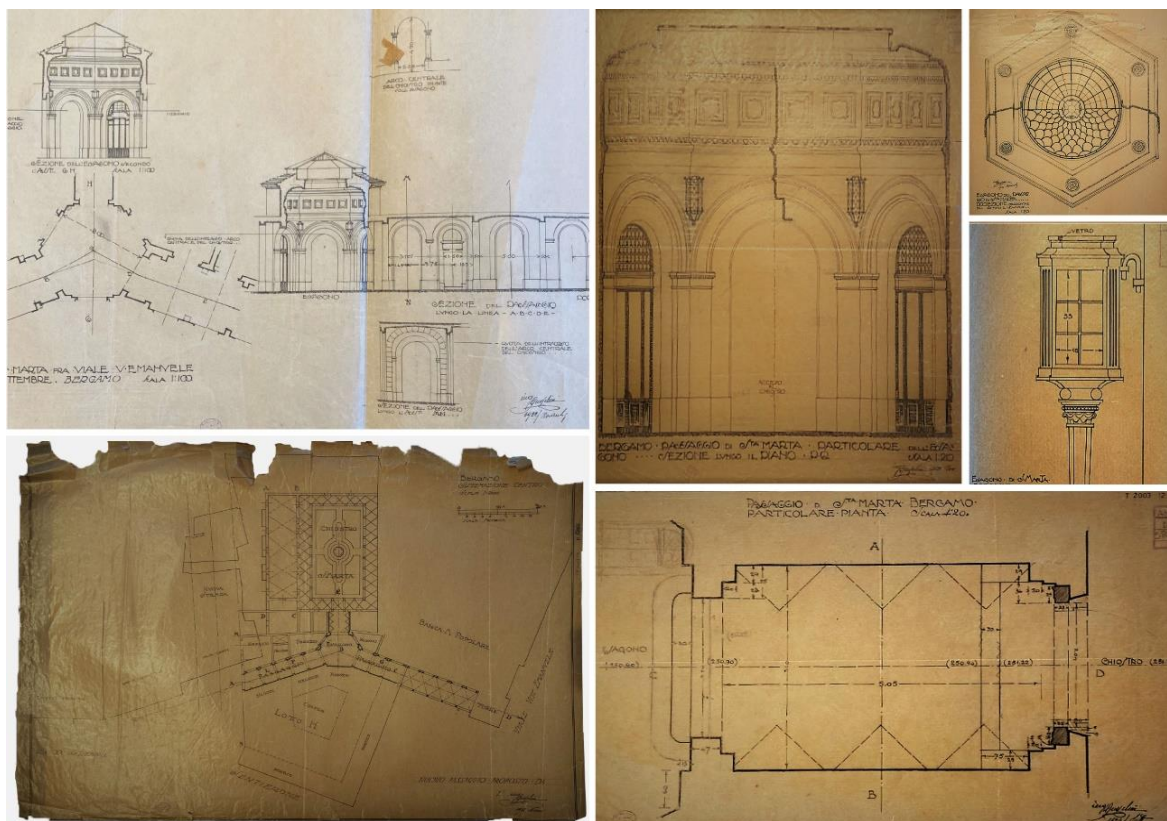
A sinistra, il passaggio di S. Marta nel progetto di Luigi Angelini: sezioni, novembre 1922 e planimetria, marzo 1922; a destra, in alto, sezione lungo il piano, particolare dell'esagono, proiezione orizzontale del soffitto e velario, dettaglio di lampada in bronzo, novembre 1922 e, in basso, particolare della pianta, settembre 1923 (BCBg, *Archivio Luigi Angelini*).
